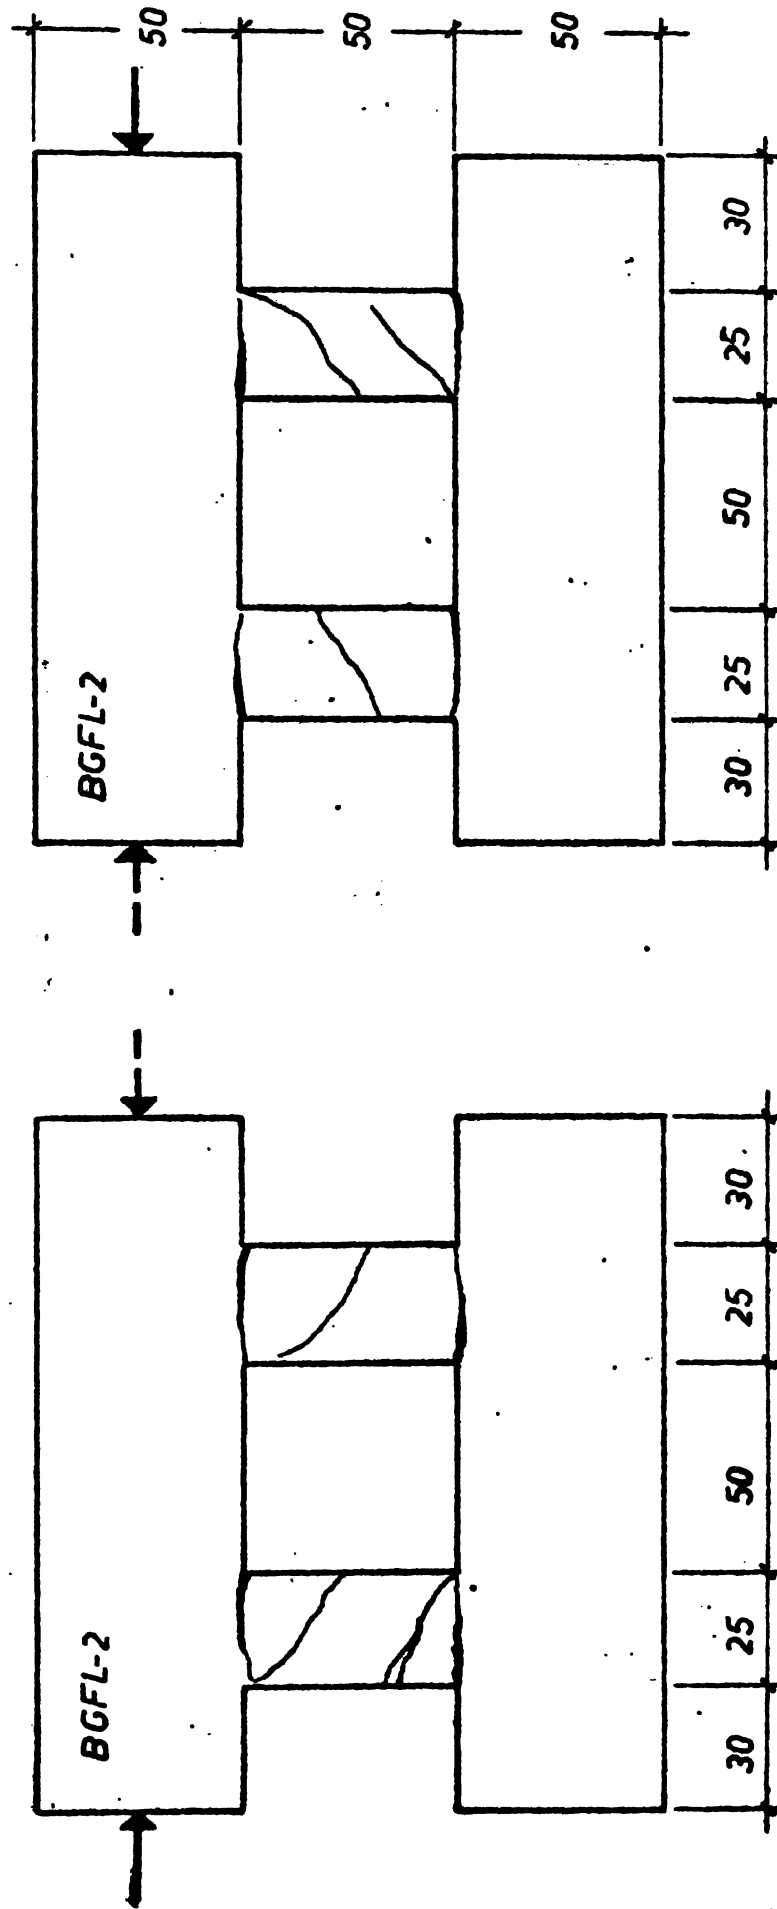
MODUL DE FISURARE A BUIANDRUGILOR ELEMENTULUI BGFL-2 LA RUPERE
